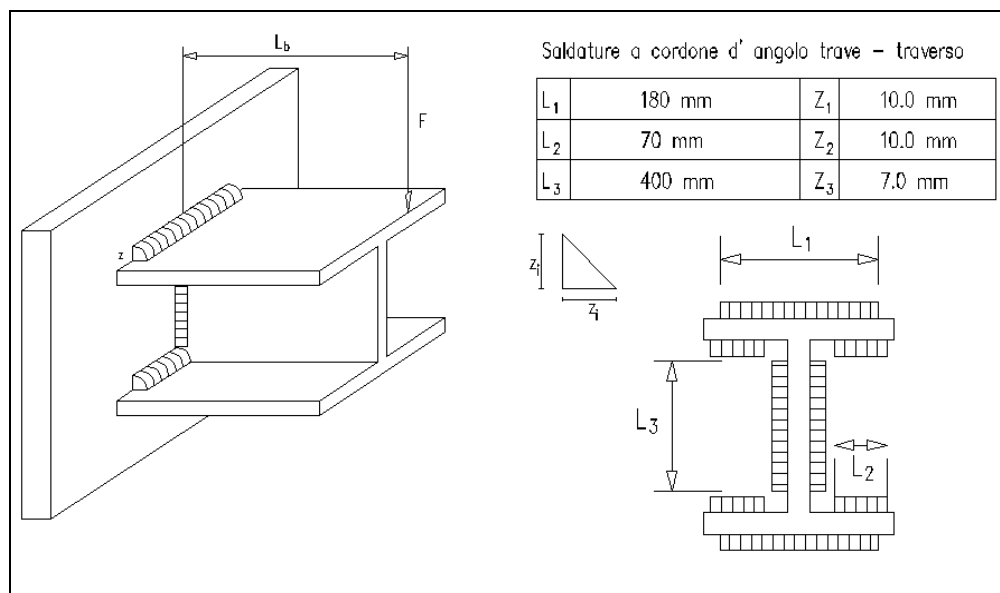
DIMENSIONI CORDONI SALDATURA
